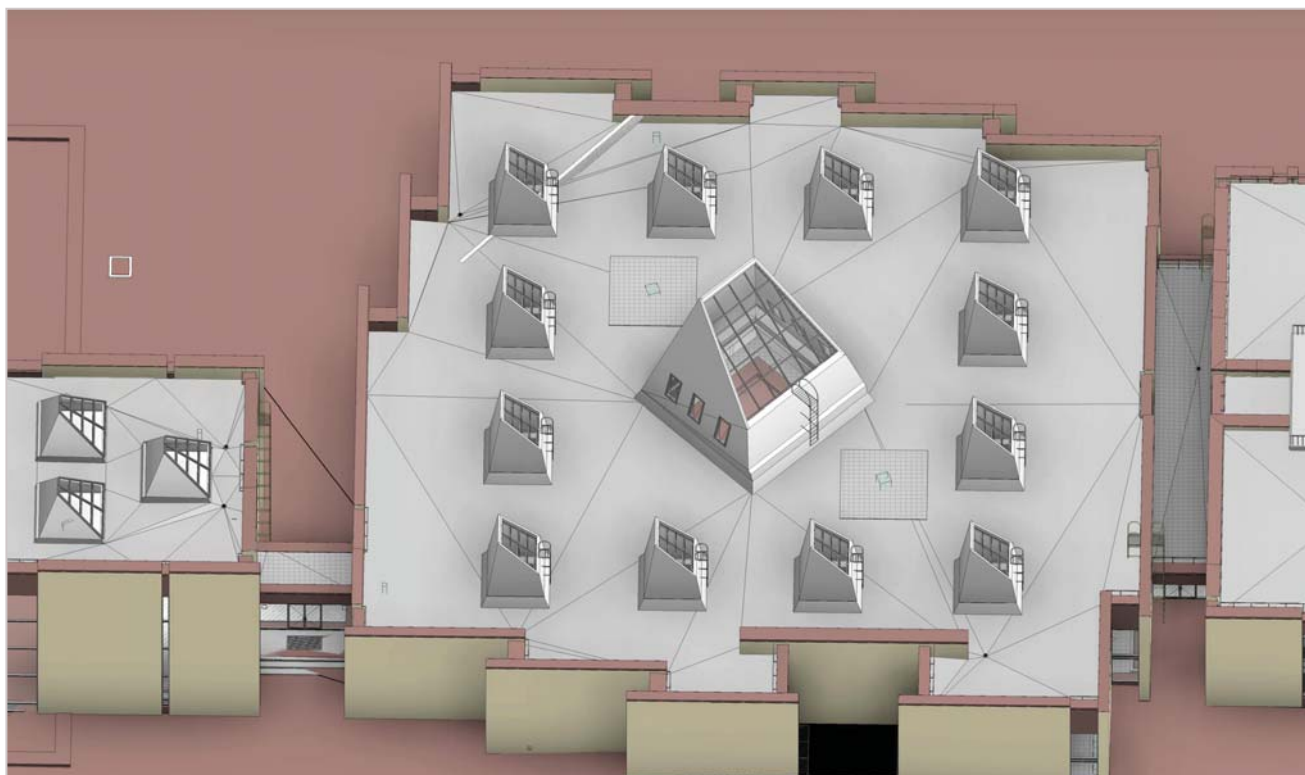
Смоделированный вид сверху на кровлю здания с фонарями
